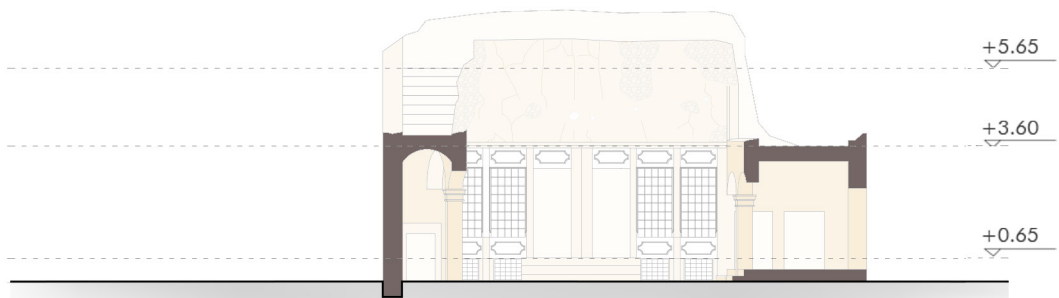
Sezione A-A della casa 10. Scala 1/200
